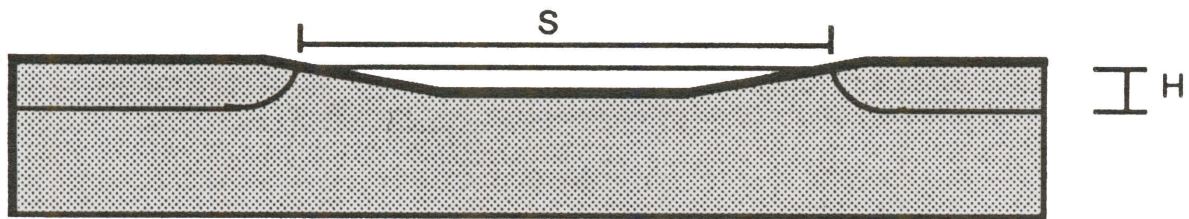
La nappe est à faible profondeur, la couche perméable est très profonde (1).
